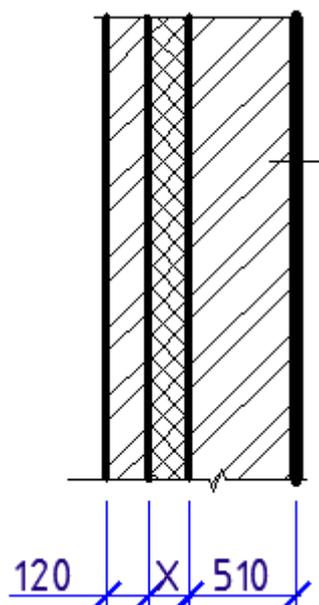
Предварительная (расчетная) конструкция стены
